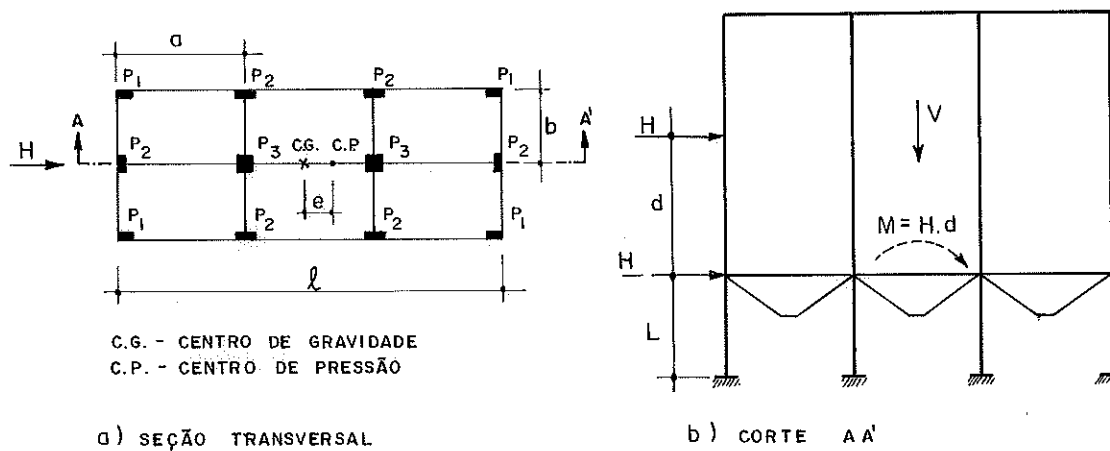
Cargas horizontais e verticais nos apoios de um silo.
